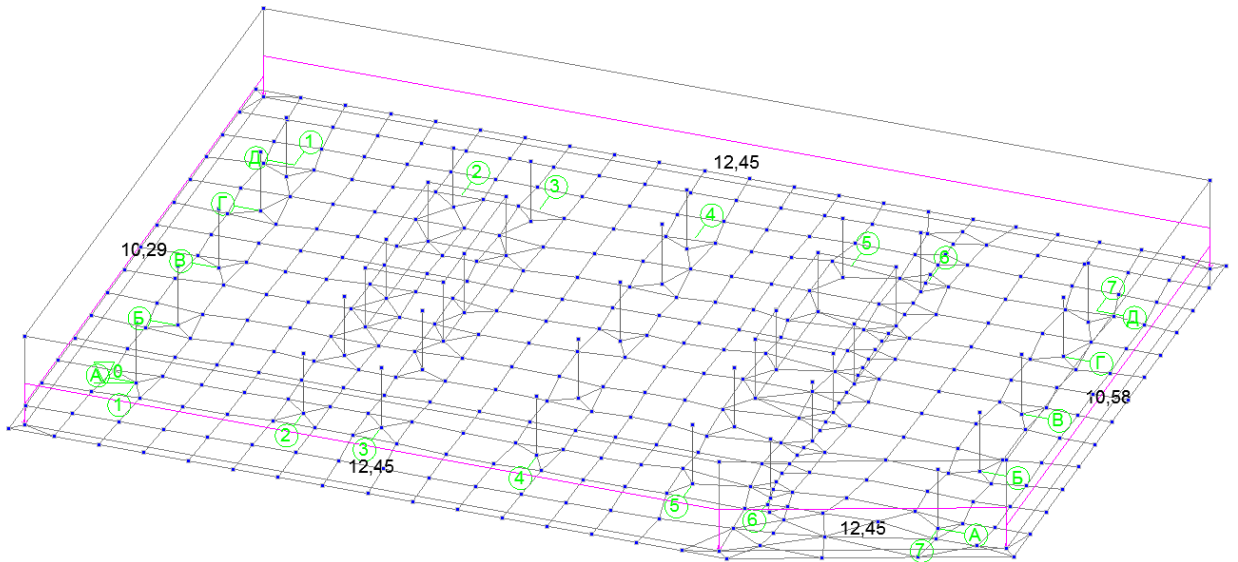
Постоянная нагрузка на фундаментную плиту
